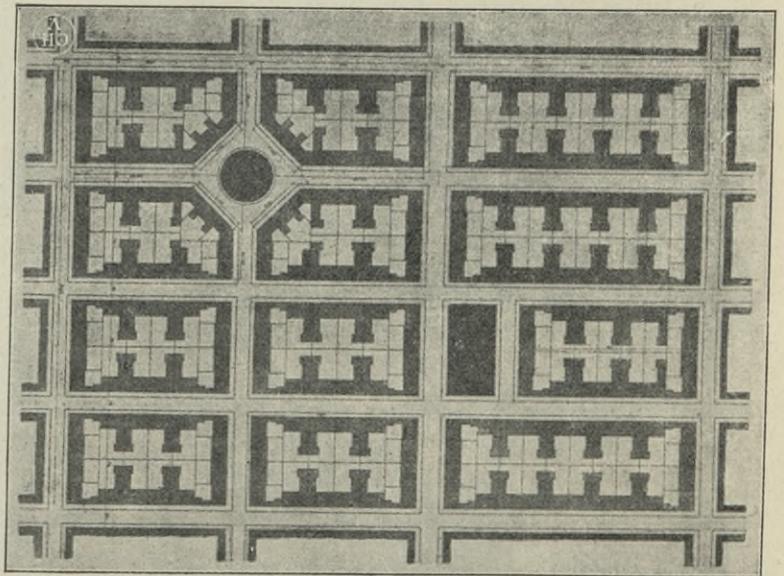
Altes System, mit breiten Straßen nach Bauklasse I bebaut
